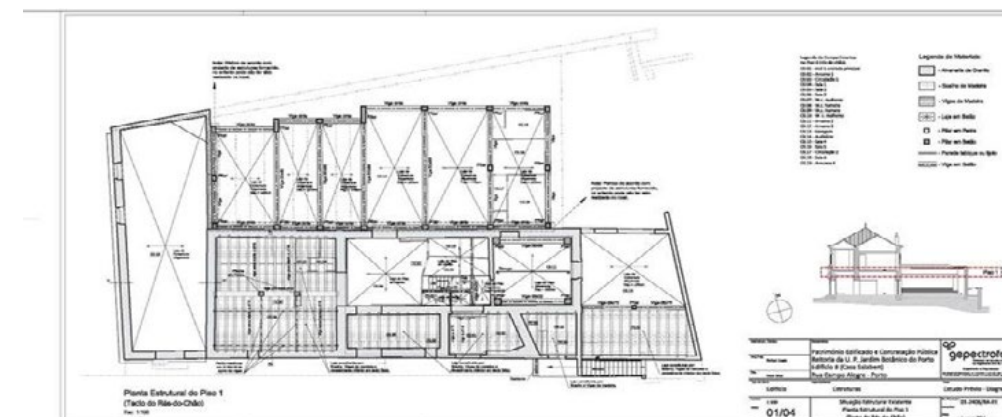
Casa Salabert – levantamento Estrutural do primeiro piso
